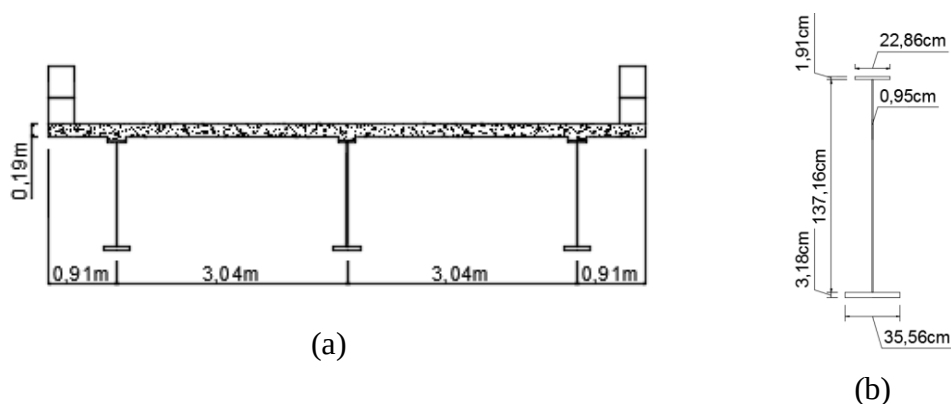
(a) Seção transversal da ponte; (b) detalhe da seção transversal da viga.
